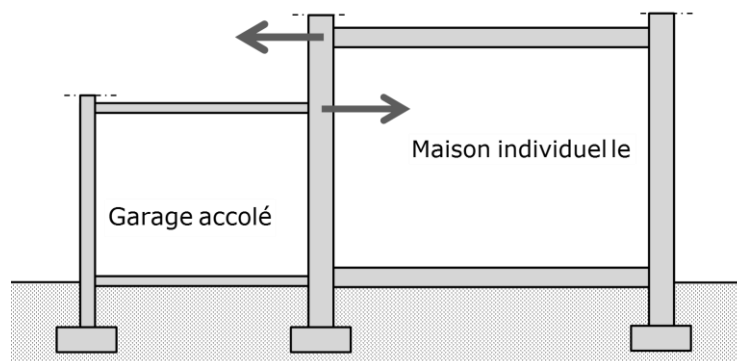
exemple de sollicitations supplémentaires sur la maison individuelle accolée à un garage
